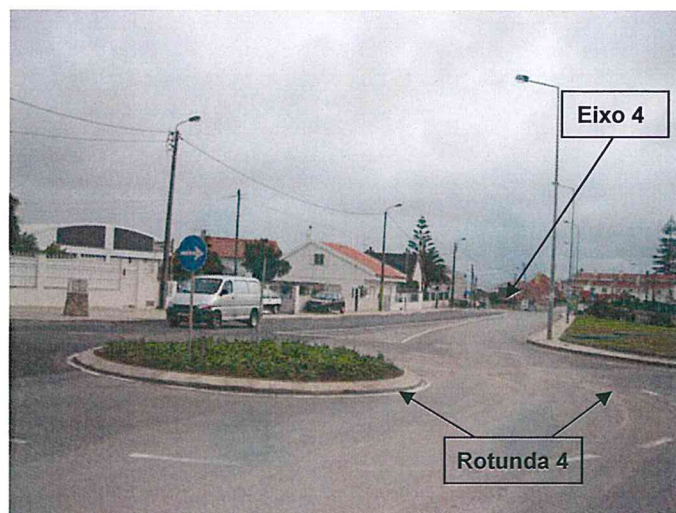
Rotunda actual a adaptar e ligação ao Eixo 4
